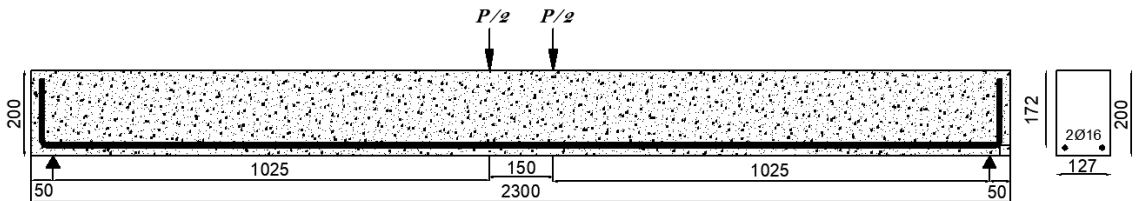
Minimum donatı oranından az donatılı numunesinin geometrik özellikleri ve donatı çizimi
